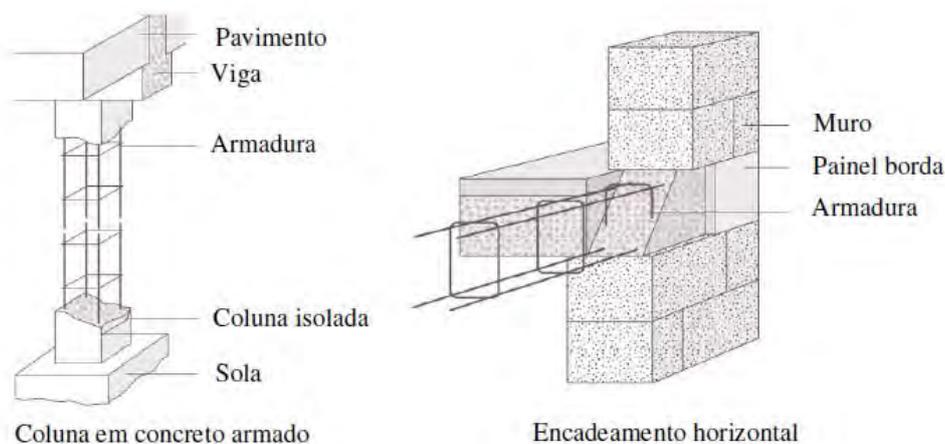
Estrutura de Concreto Armado.⁽¹⁾
